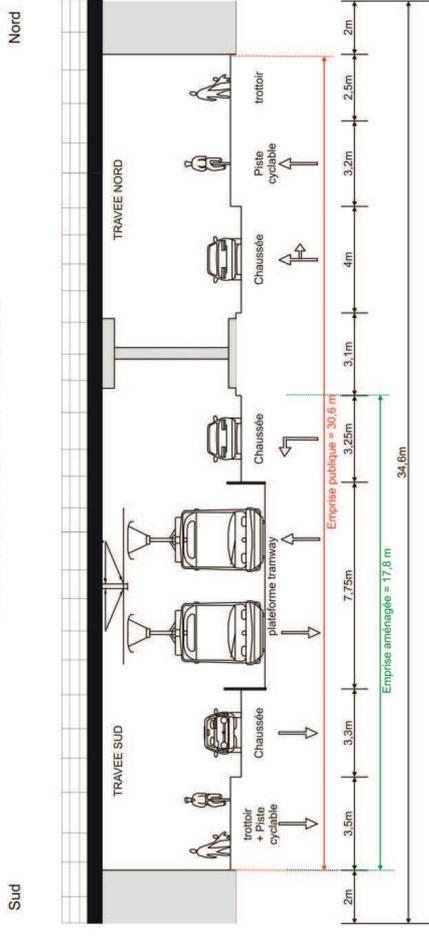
Aménagement projeté – coupe 33 – sur la rue de Koenigshoffen (pont 3)
